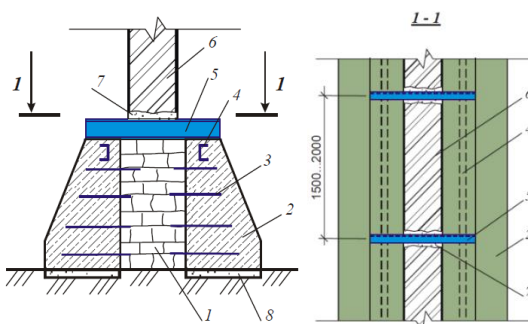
Усиление фундаментов монолитными бетонными банкетами:
